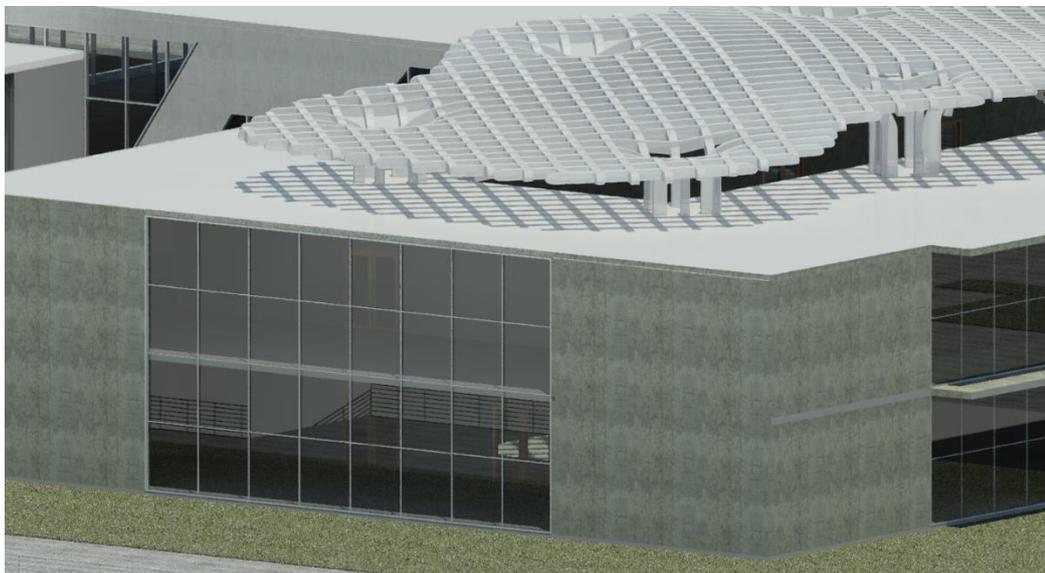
Detalle del uso de concreto caravista en fachadas.
